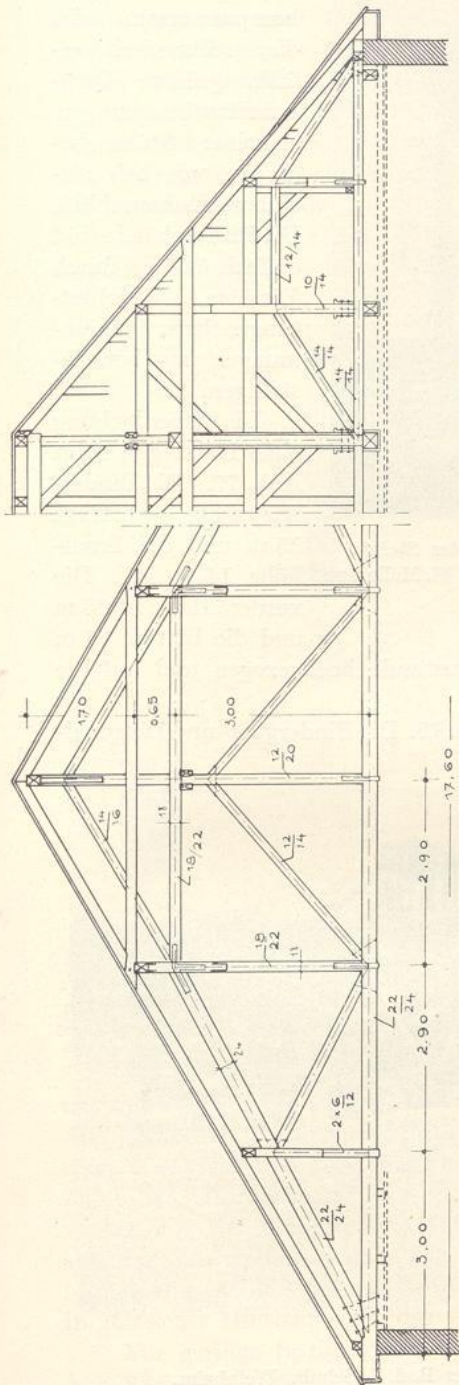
Vorschlag zu einem Dachbinder für eine Berufsschule in Bottrop i. Westf. Bearbeitet: T. K.
